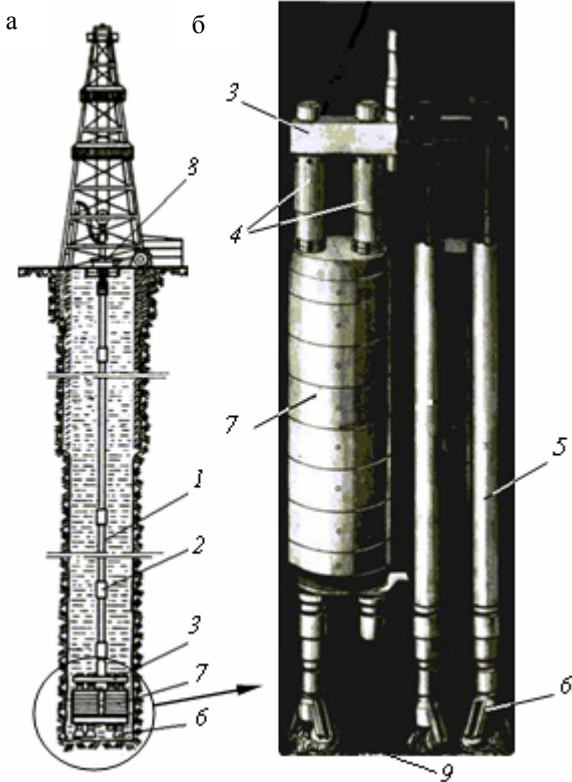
Общій вид бурової установки с РТБ и забойного агрегата: а – общій вид бурової установки с РТБ; б – забойний агрегат РТБ
